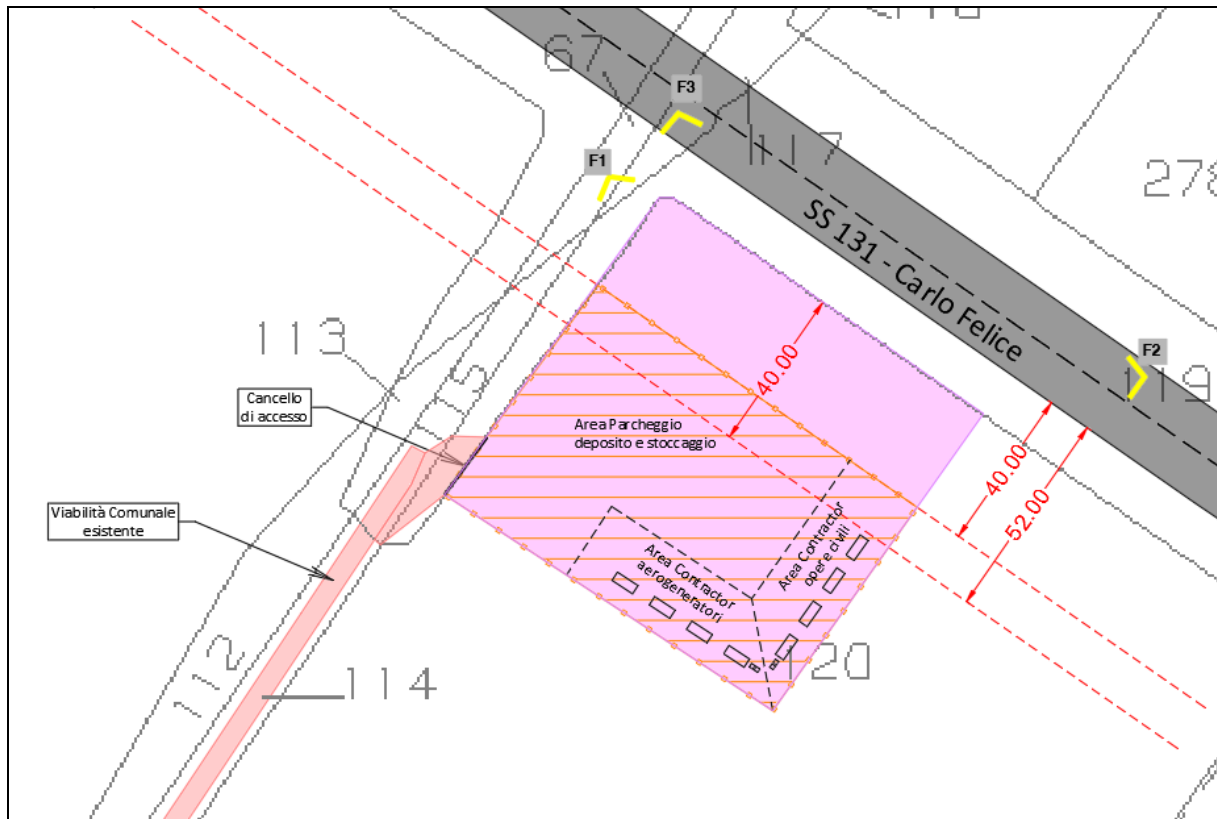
planimetria di dettaglio dell'area di cantiere e trasbordo con l'ubicazione dei baraccamenti e l'indicazione della distanza dal confine catastale e dal nastro stradale di pertinenza ANAS. Con colore rosa è indicata la sagoma dell'area di cantiere come da progetto originario; con la retinatura di colore arancione, l'area di cantiere rimodulata per renderla coerente con le distanze dal confine catastale e dal nastro stradale della S.S. 131. Come evidente, è stato stralciato l'accesso all'area di cantiere dalla S.S. 131.
